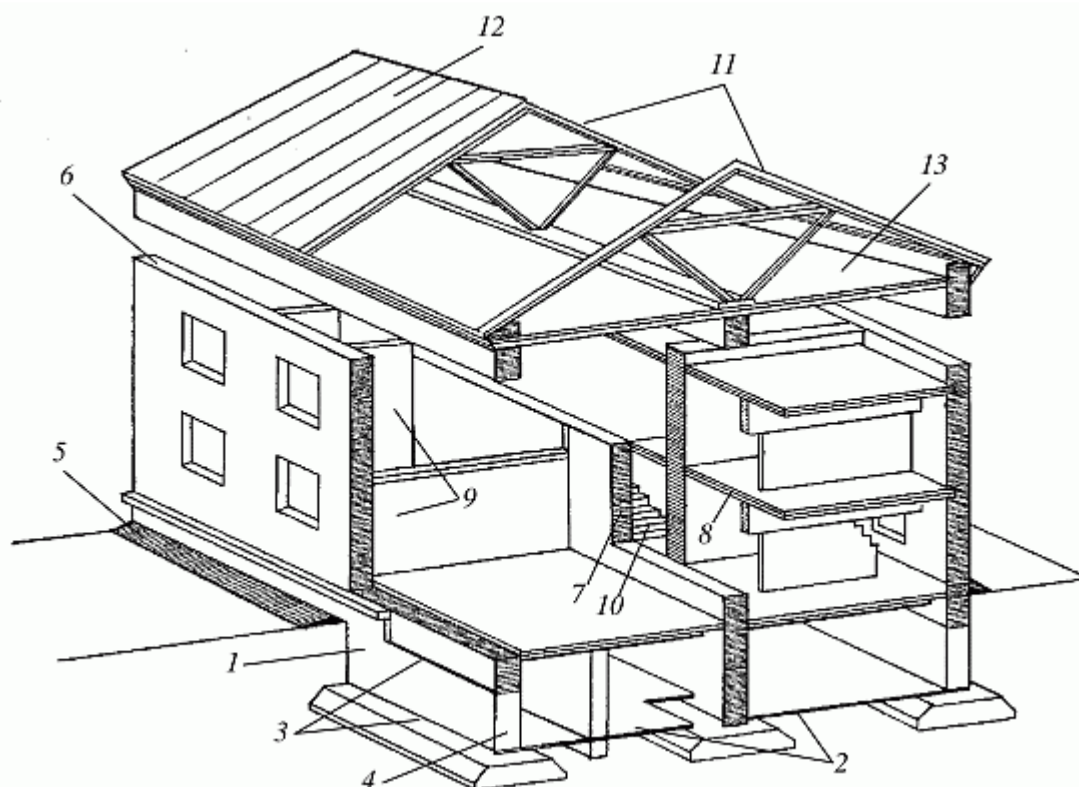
Схема двухэтажного дома: 1 – фундамент; 2 – пол подвала; 3 – гидроизоляция; 4 – стены подвала; 5 – отмостка; 6 – наружные стены; 7 – внутренние стены; 8 – междуэтажные перекрытия; 9 – перегородки; 10 – лестница; 11 – стропила; 12 – кровля; 13 – чердачное перекрытие
